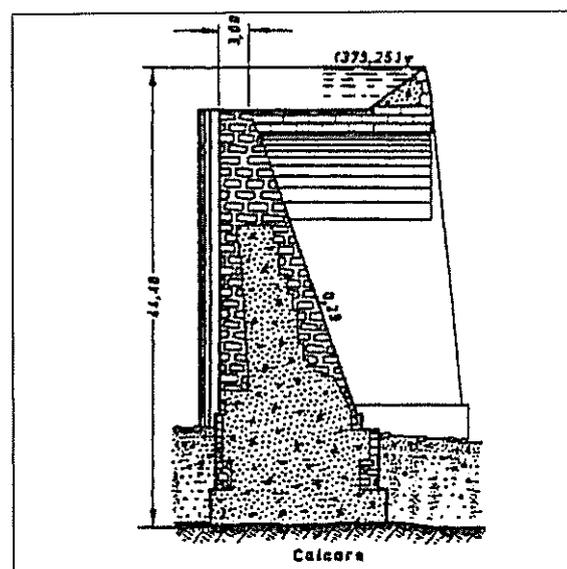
Diga di Ponte Serra: Sezione tipo.
